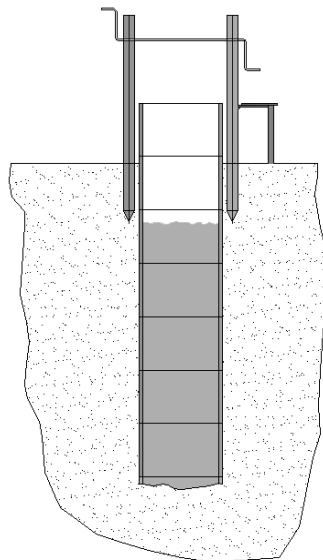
Опалубка для его изготовления представлена щитами-модулями габаритами:
